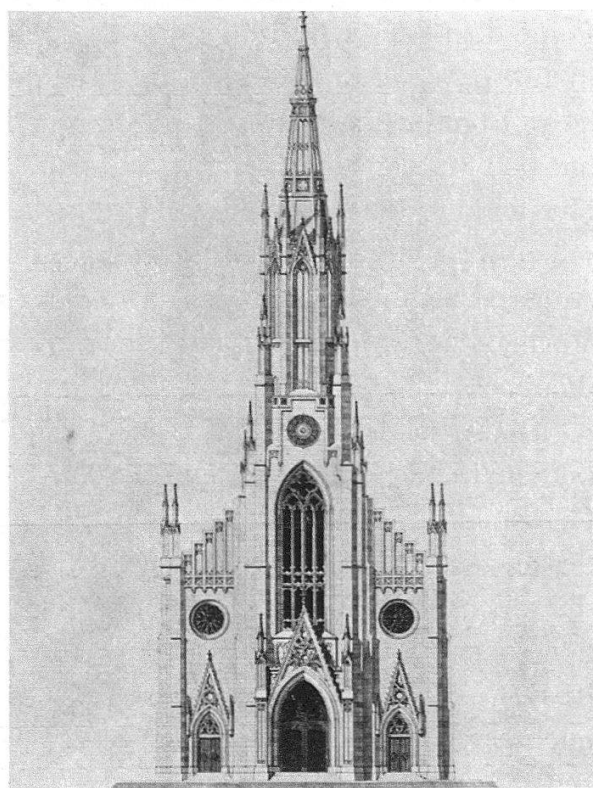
Basel. Projekt für die Elisabethenkirche von Caspar Joseph Jeuch, 1857. «Vordere Façade» (Staatsarchiv Basel-Stadt, Plan F 2.9)
